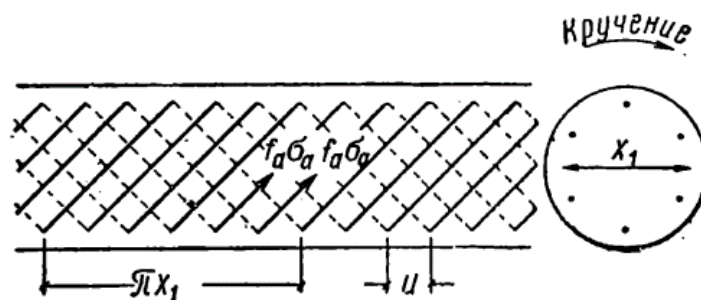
Железобетонный стержень круглого сечения со спиральным армированием
